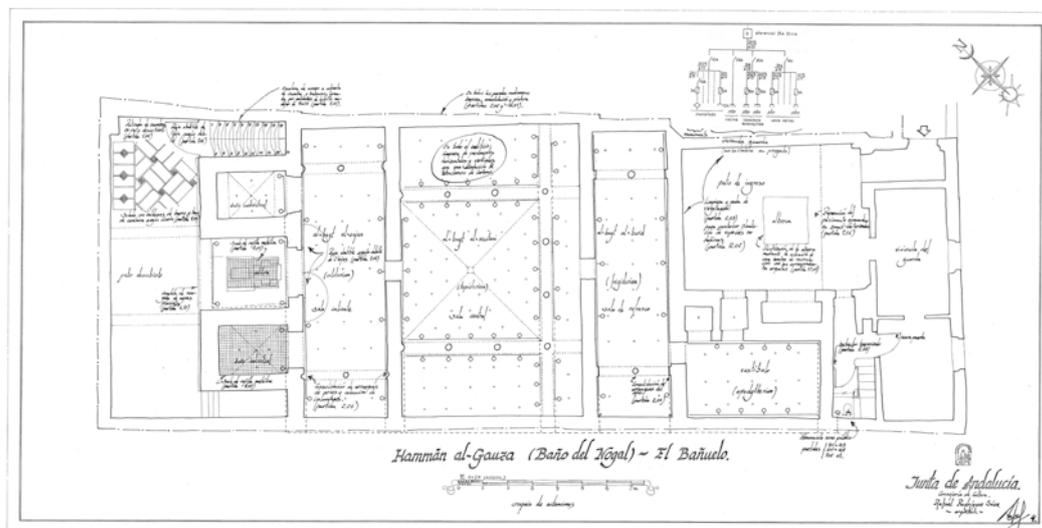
Plano del proyecto del arquitecto Rafael Rodríguez Sáez donde se aprecia el detalle de la solería del patio norte y de la escalera que da acceso a la cubierta
